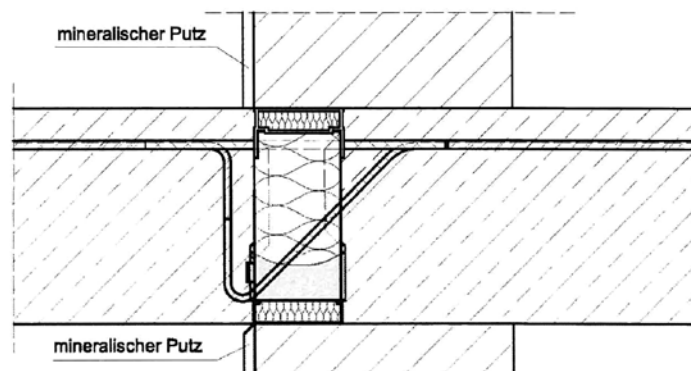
Schöck Isokorb (F30/REI30) gem. Abschnitt 2.1.3
